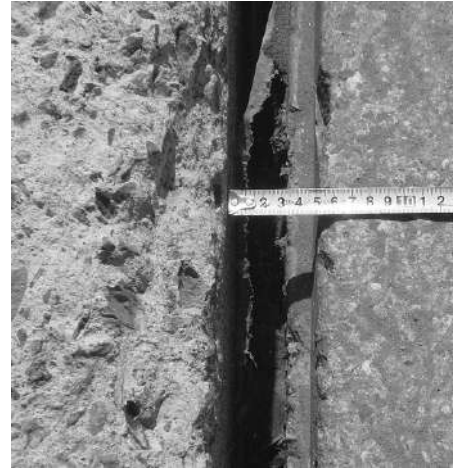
諏訪下地区岸壁 (-5.5m)
